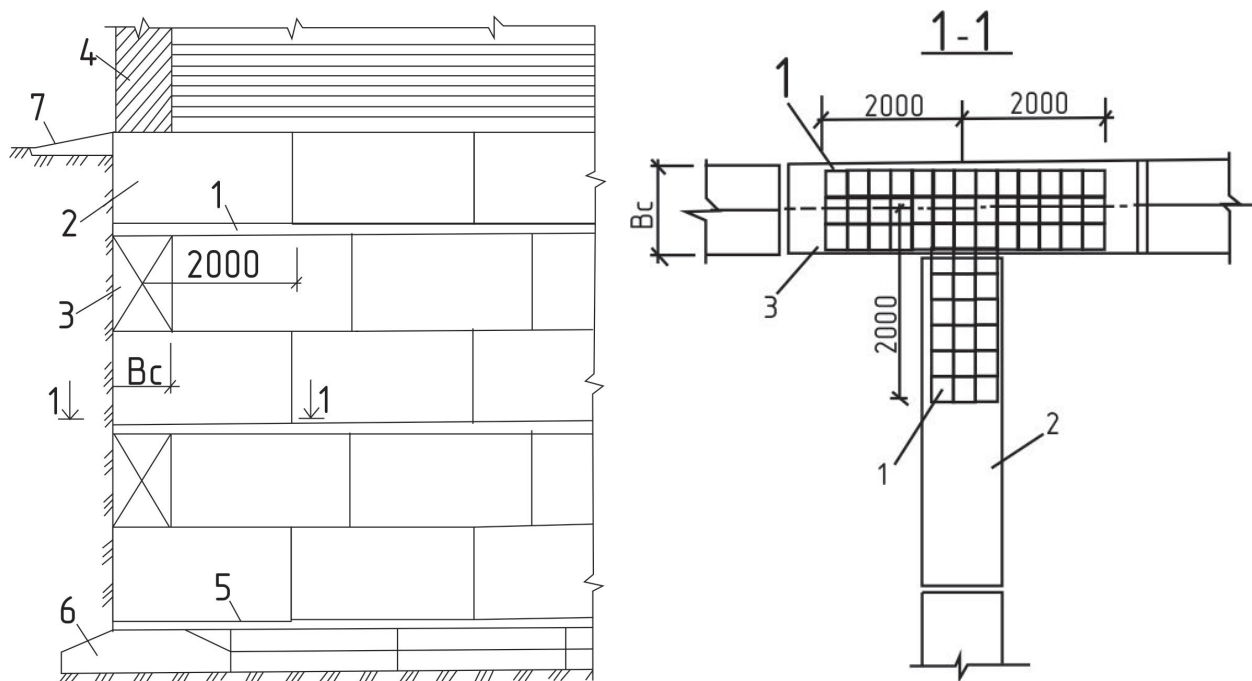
Усиление сопряжений сборных фундаментов
